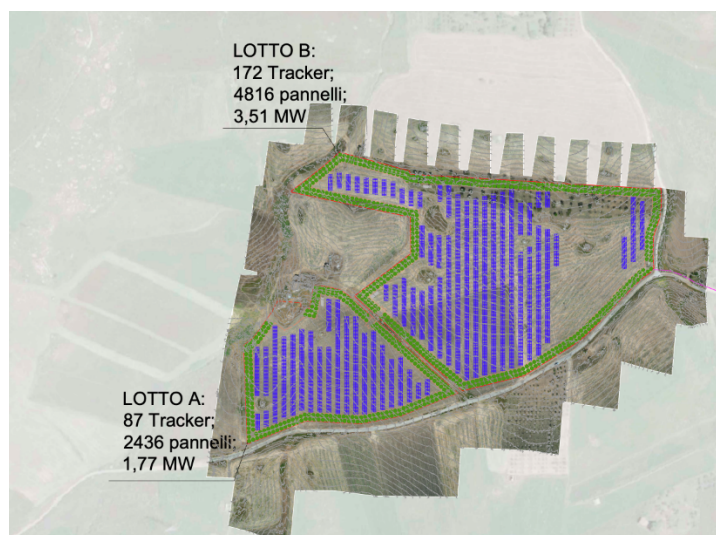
Particolare Layout di impianto area A e area B su stralcio rilievo
